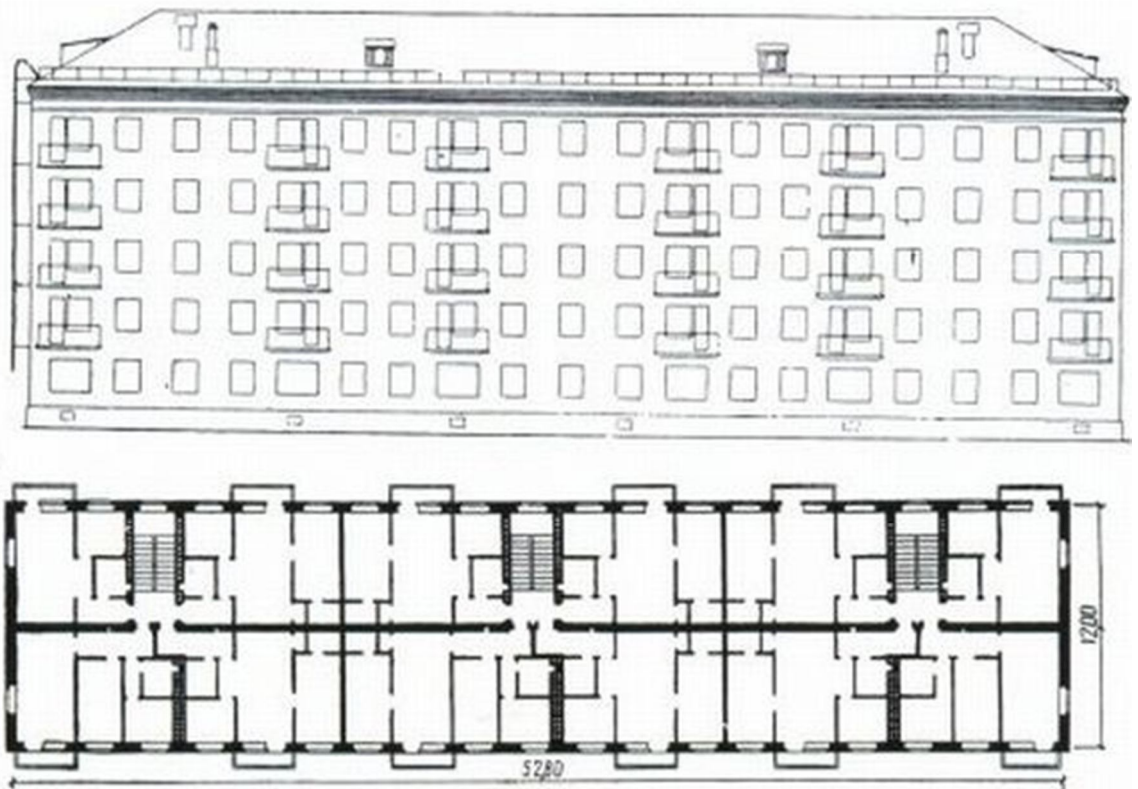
План та фасад будинку 1- 511 серії
